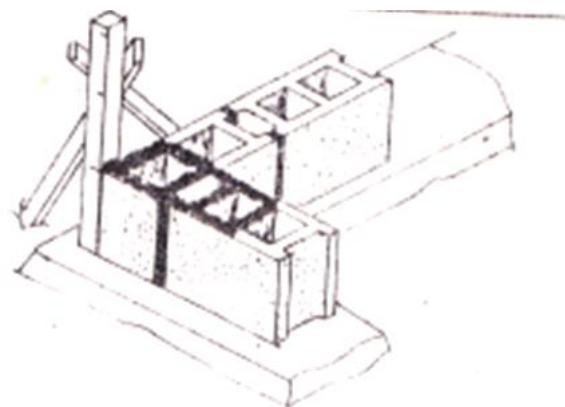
Pemasangan baja beton di pertemuan pasangan batako
